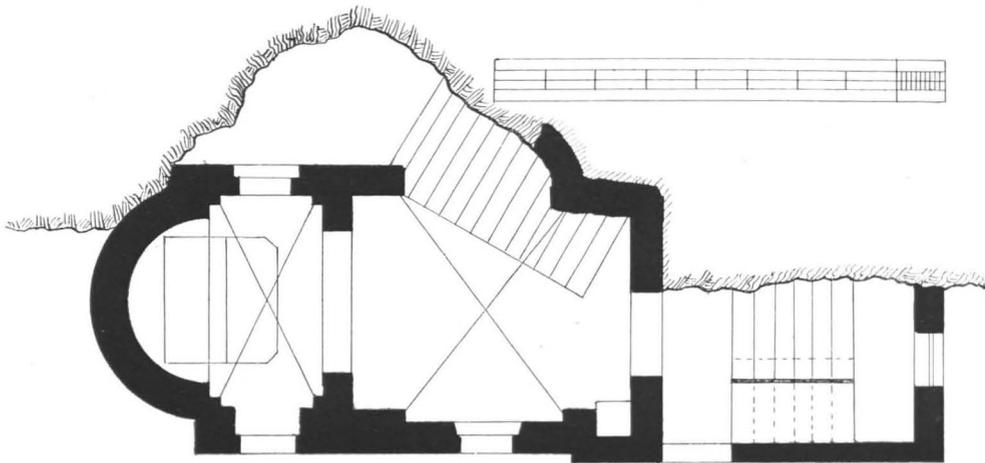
Falkensteinkirche, Grundriß 1:50 (S. 4)
